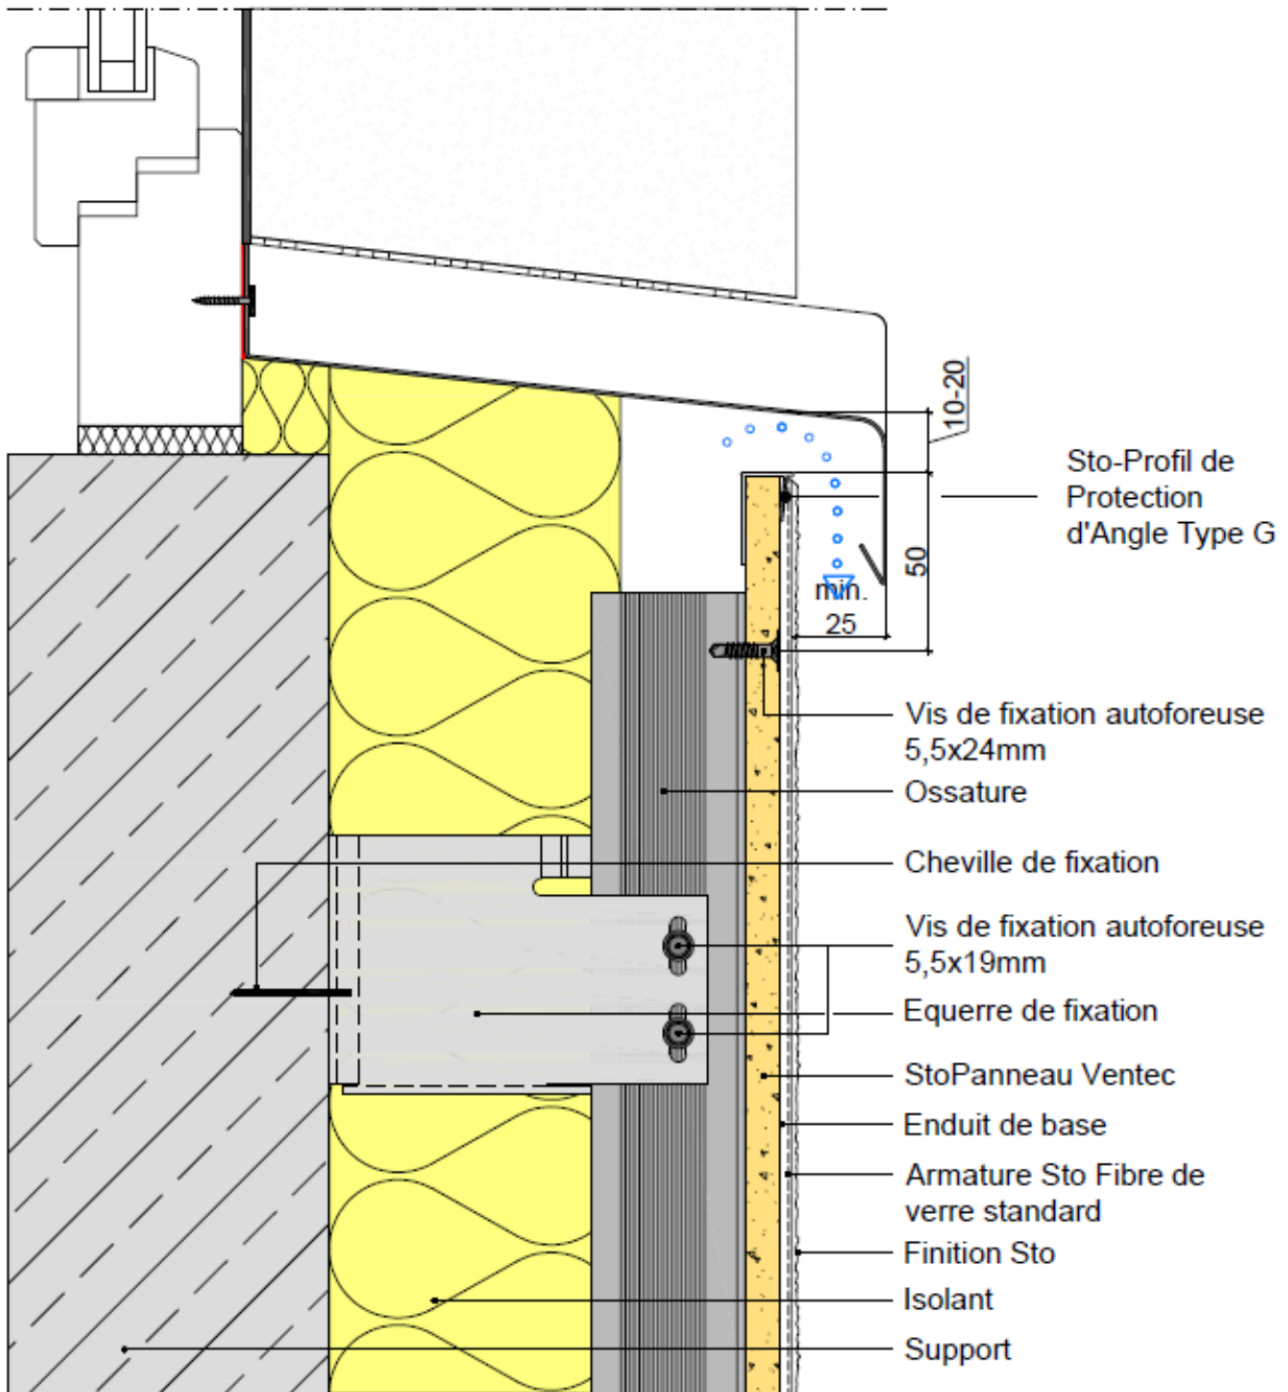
Coupe verticale - Menuiserie posée en tunnel- Appui de fenêtre - Ossatures aluminium sur support béton
